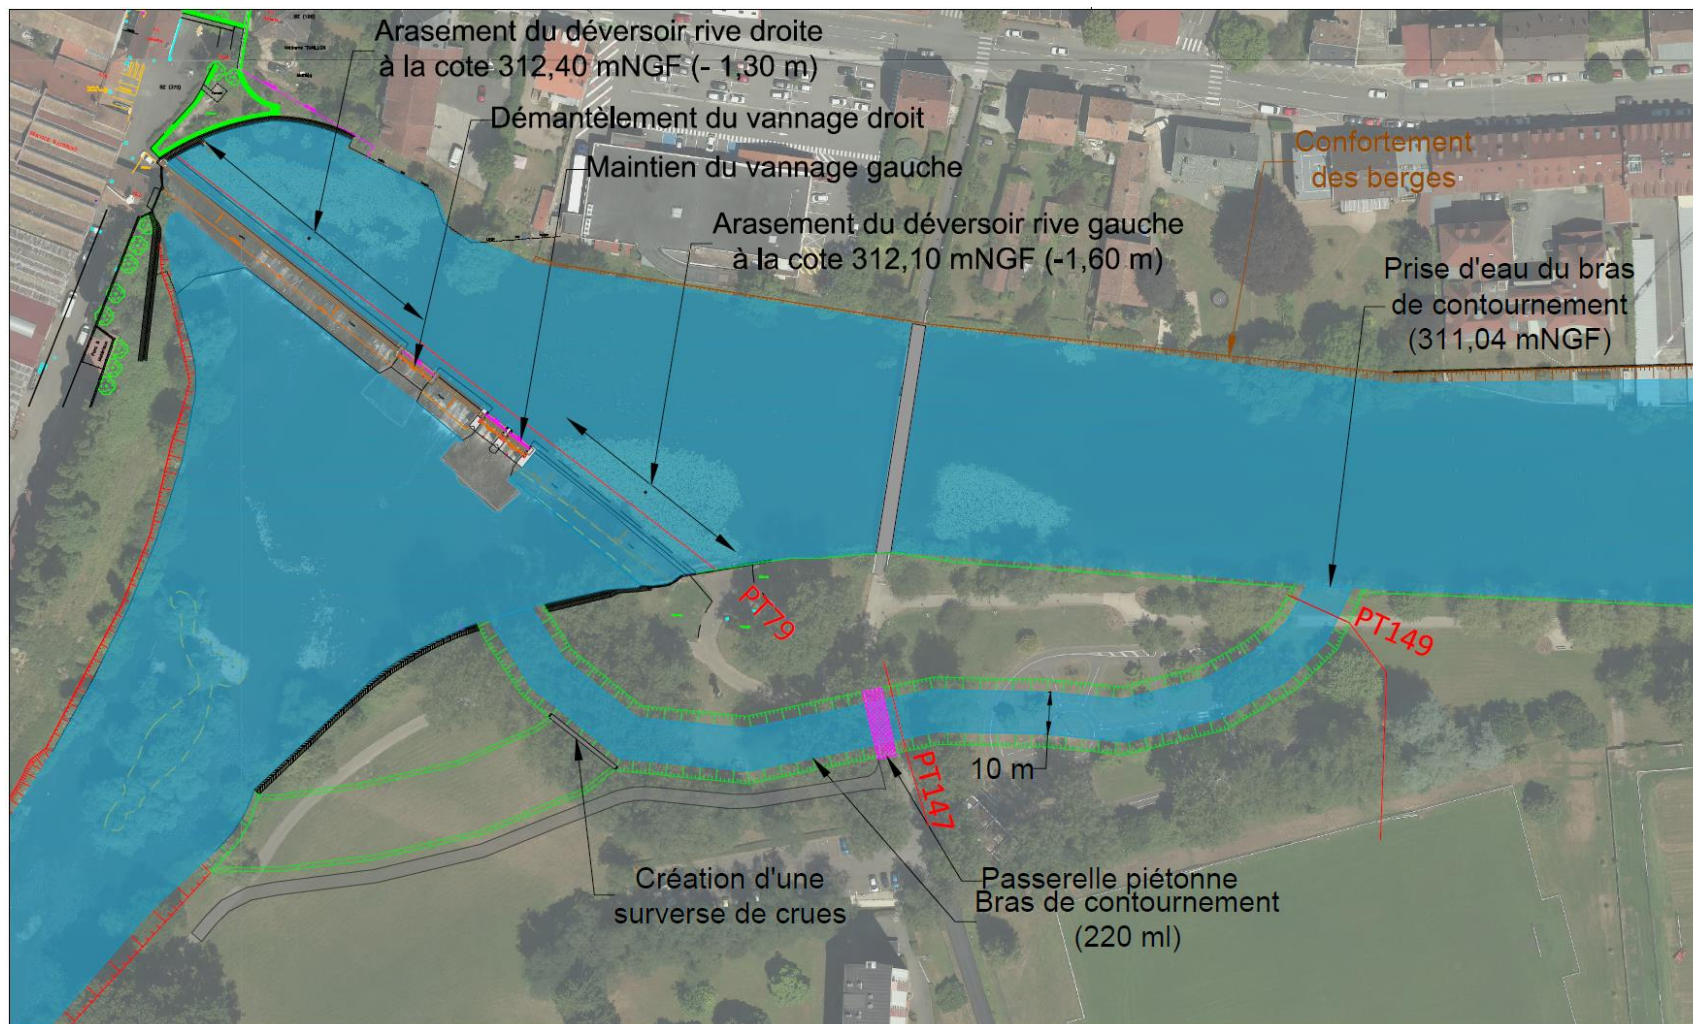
Plan de masse au droit du barrage en état aménagé (scénario RCE2)
